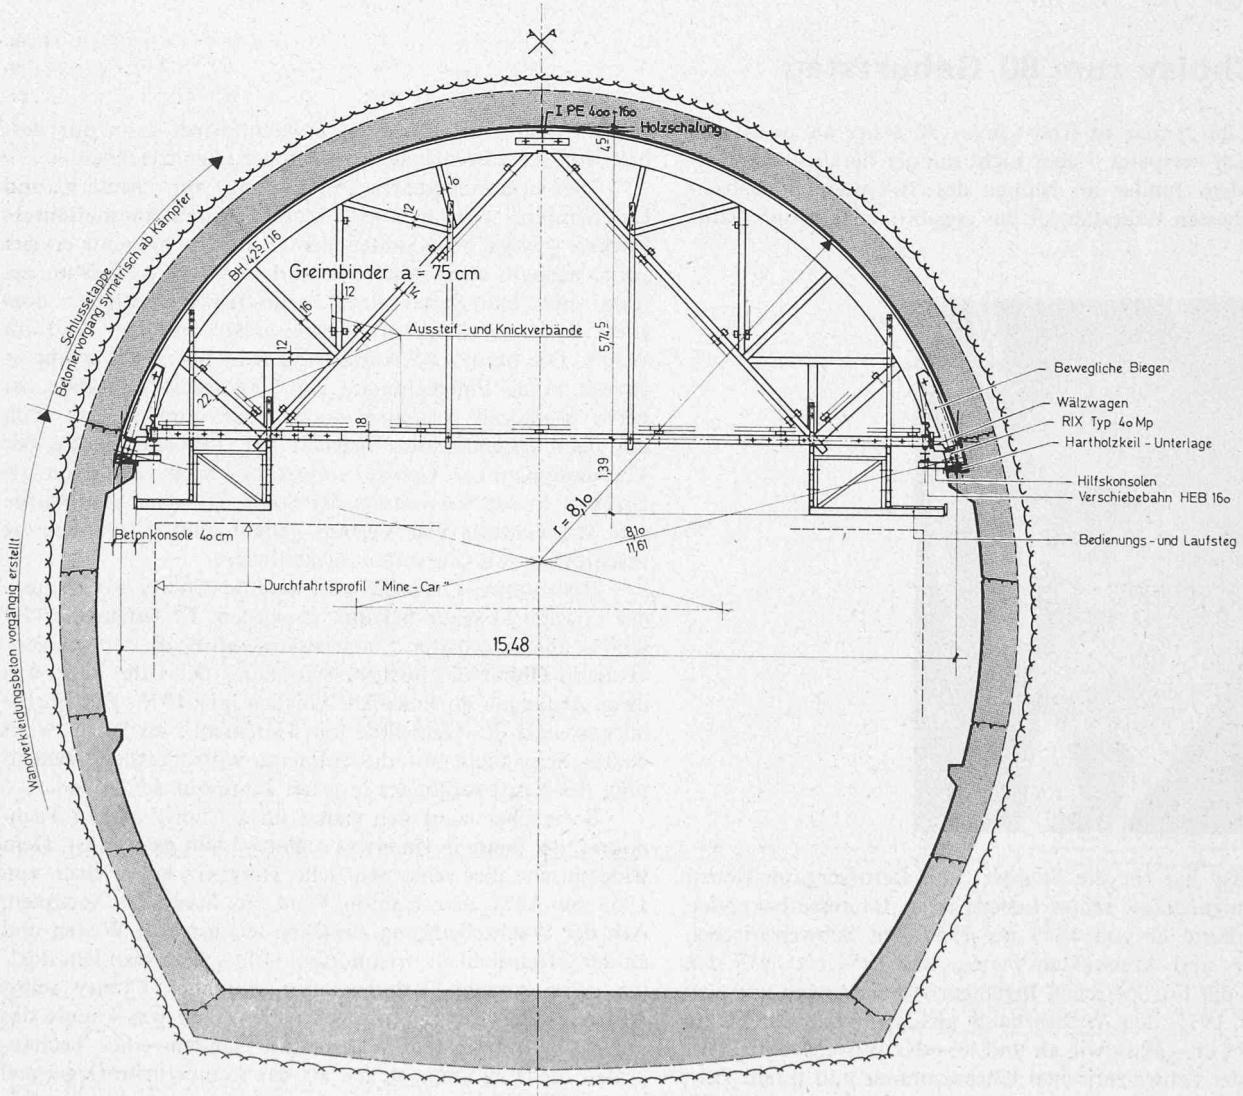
Ansicht des Lehrgerüstes zum Kavernengewölbe, Spannweite 15,40 m
